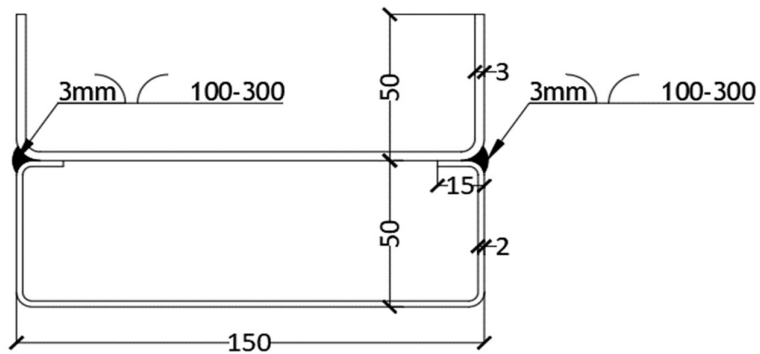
Detalle de soldadura de unión C150x50x3-G150x50x15x3
